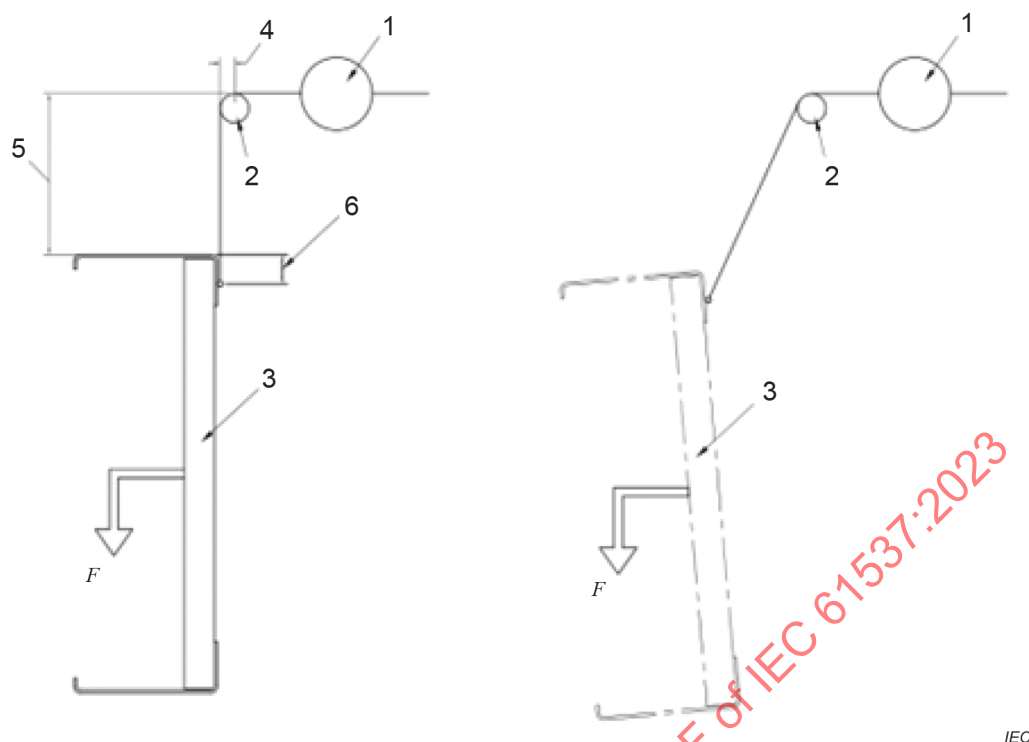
Conditions d'essai: Echelle à câbles en travée unique montée dans le plan vertical et cheminant horizontalement
